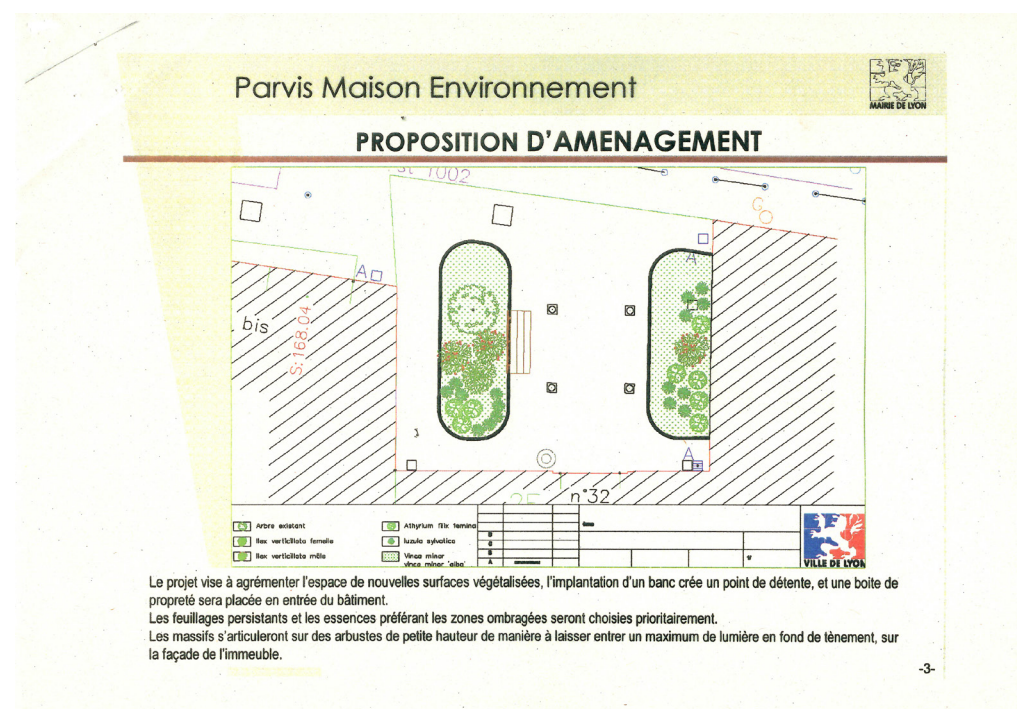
Plan de plantations du jardin proposé par la ville de Lyon.
